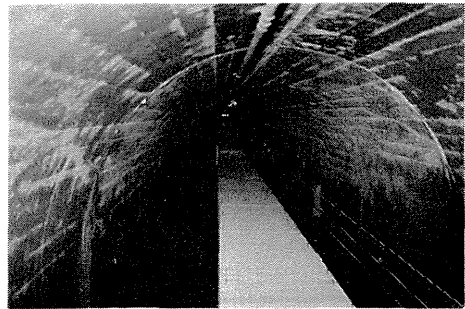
山崎断層観測坑道（兵庫県安富町）
